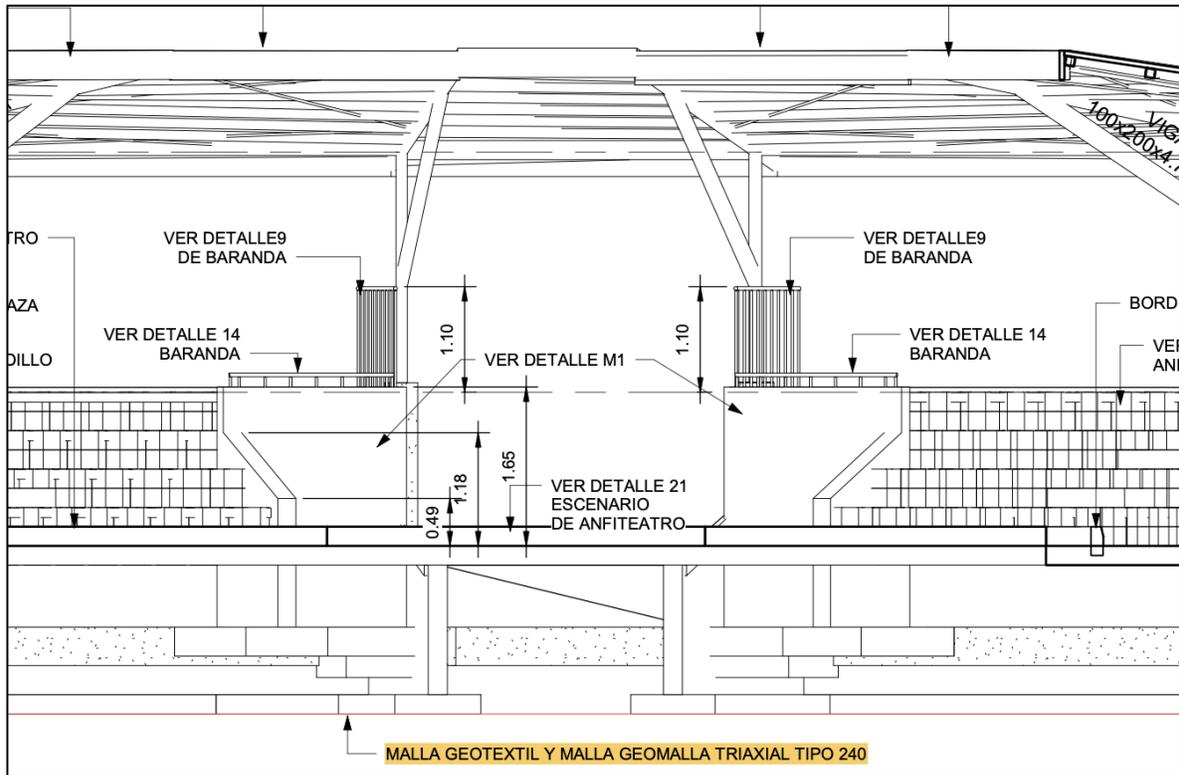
Malla geotextil anfiteatro. Fuente: planos de anteproyecto.
